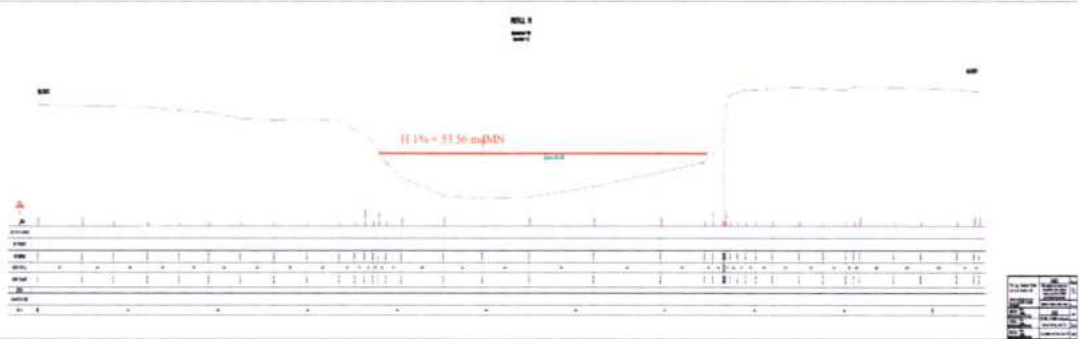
Profil transversal (3) ridicat prin cursul de apă Coletina
